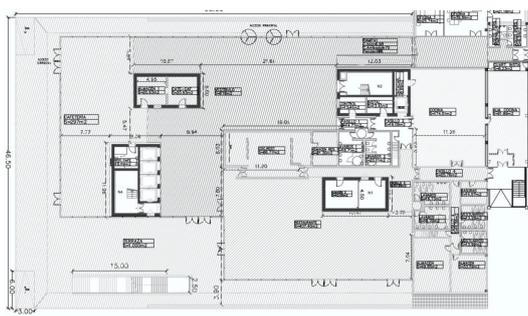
Planta baja del edificio. Fuente: (Pons, 2016)
